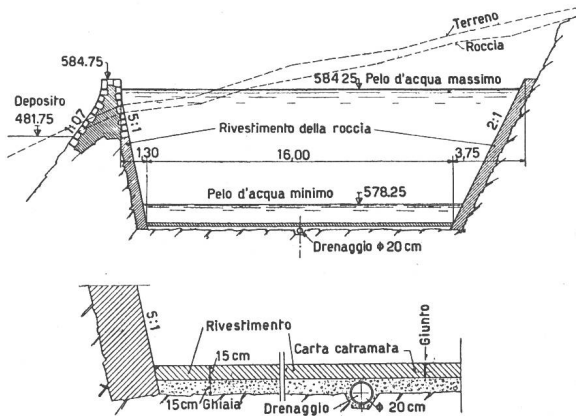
EW Massagno. Ausgleichsbecken. Oben: Querschnitt, unten: Detail der Bodenverkleidung.
